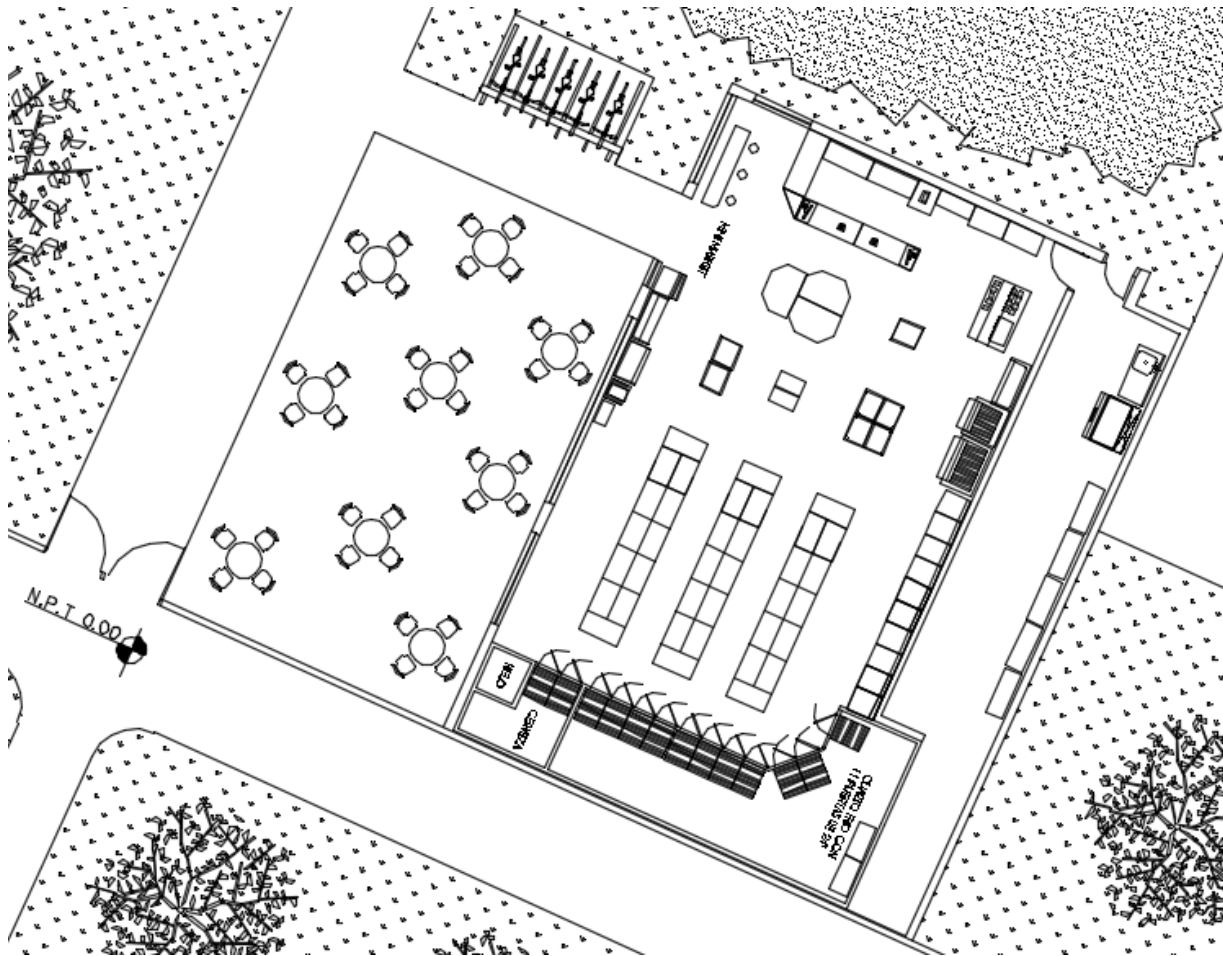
Mini-market del conjunto Álmar 1800 - Fuente: Propia
